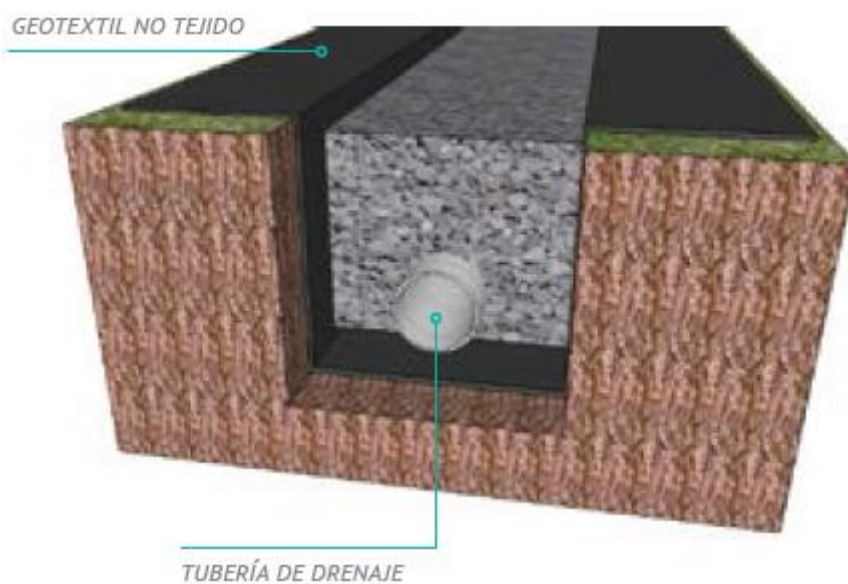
Alternativa 2: Sub drenaje tipo francés.
